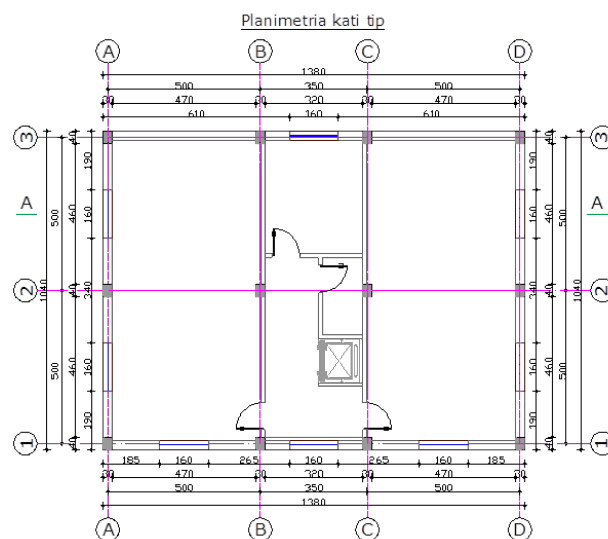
Planimetria e kati tip (objekti 3 dhe 5 kat)
